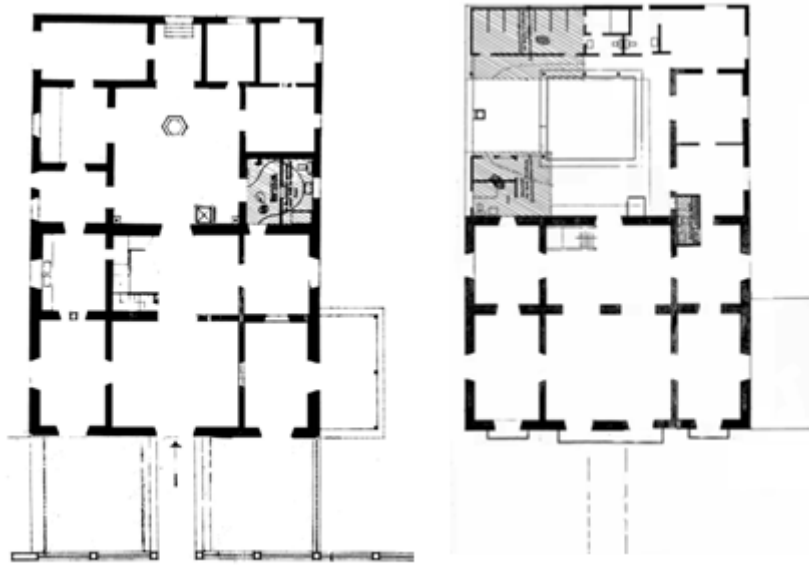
Esquema planimétrico de la casa vivienda Sarría Atkins. Planta baja y segundo nivel en la actualidad.
